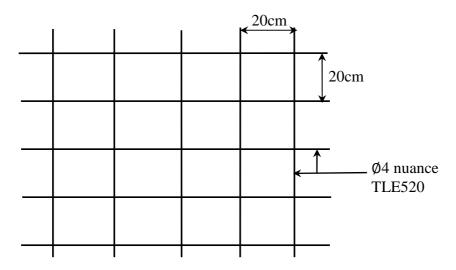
Treillis soudé de (20×20) cm².
